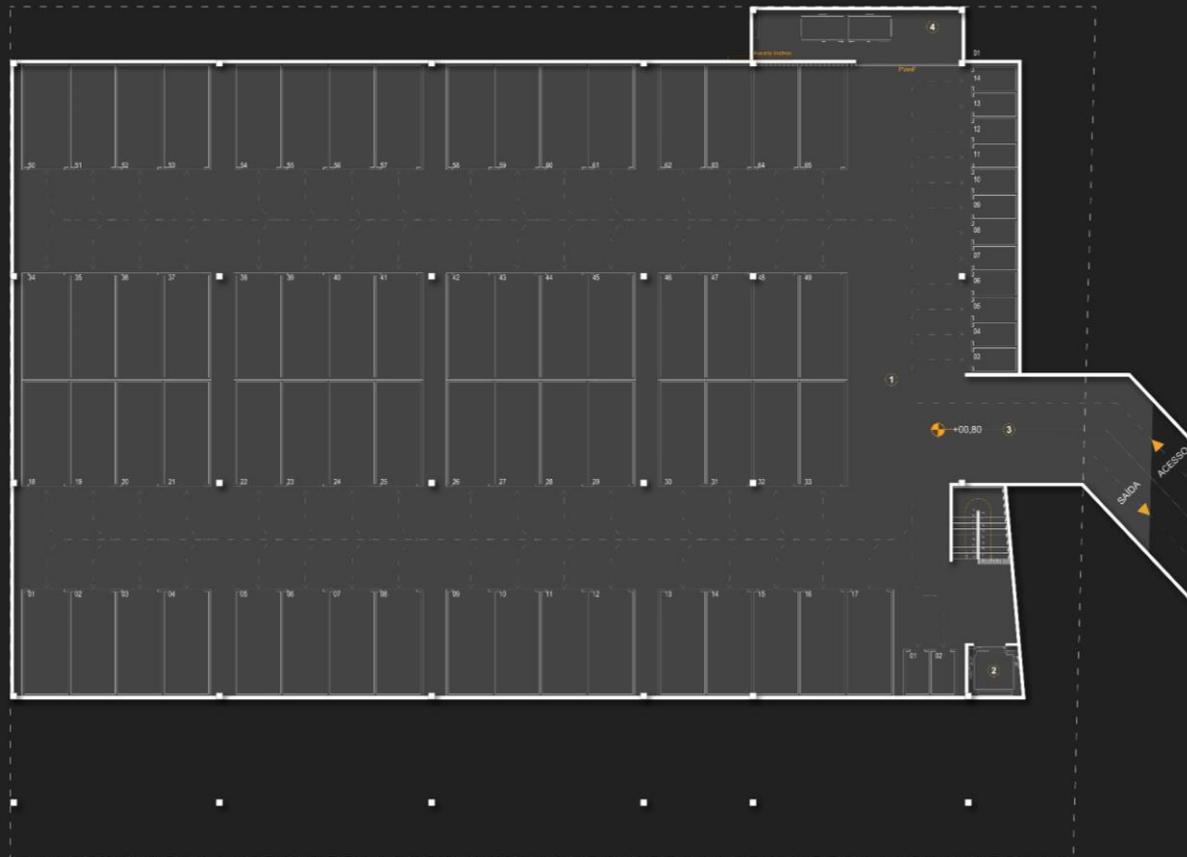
PLANTA PAVIMENTO SEMIENTERRADO
